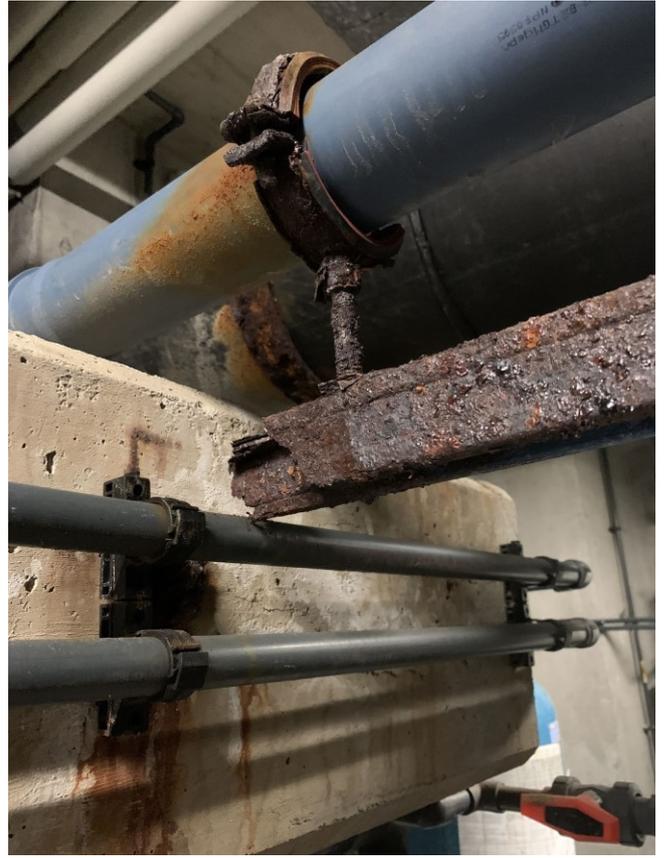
durchgerosteter (ehemals) tragender Stahlbauteil
